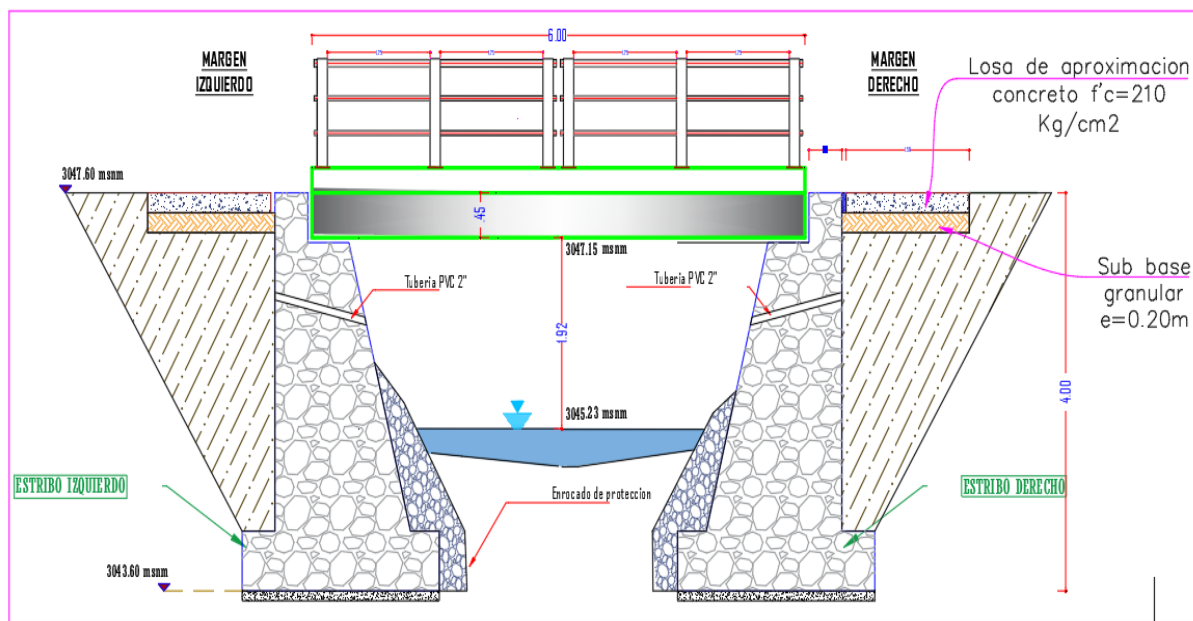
Vista de Ancho total del puente (S=5.80m)
